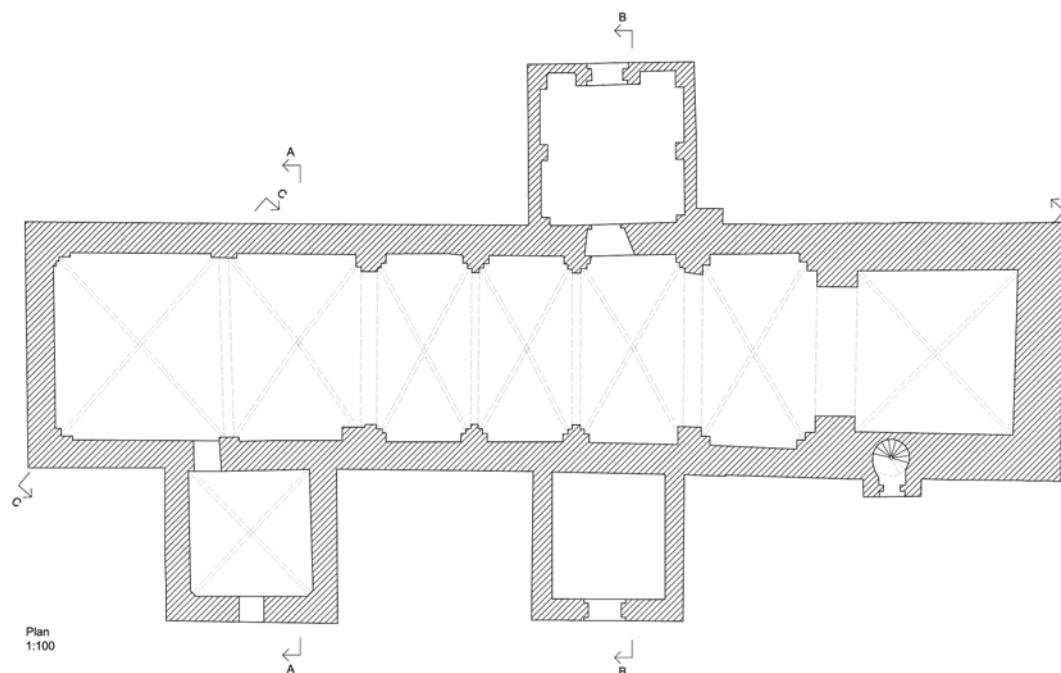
Høje Tåstrup Kirke, plan. Planen angiver placeringen af det diagonalsnit, hvor tryk-linjen i hvælvet beregnes. Planen anvendes, i den forbindelse, til beregning af lastoplandet.
